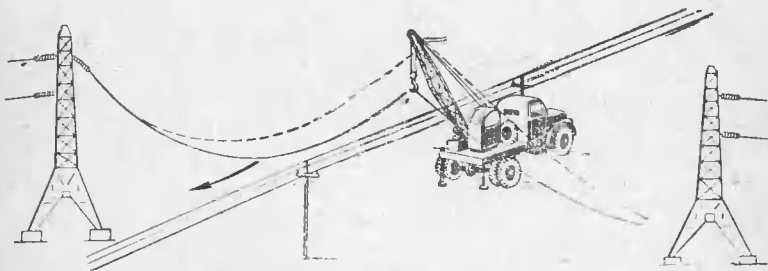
Монтаж и демонтаж провода линии электропередачи в месте пересечения с воздушной линией с помощью автокрана.
